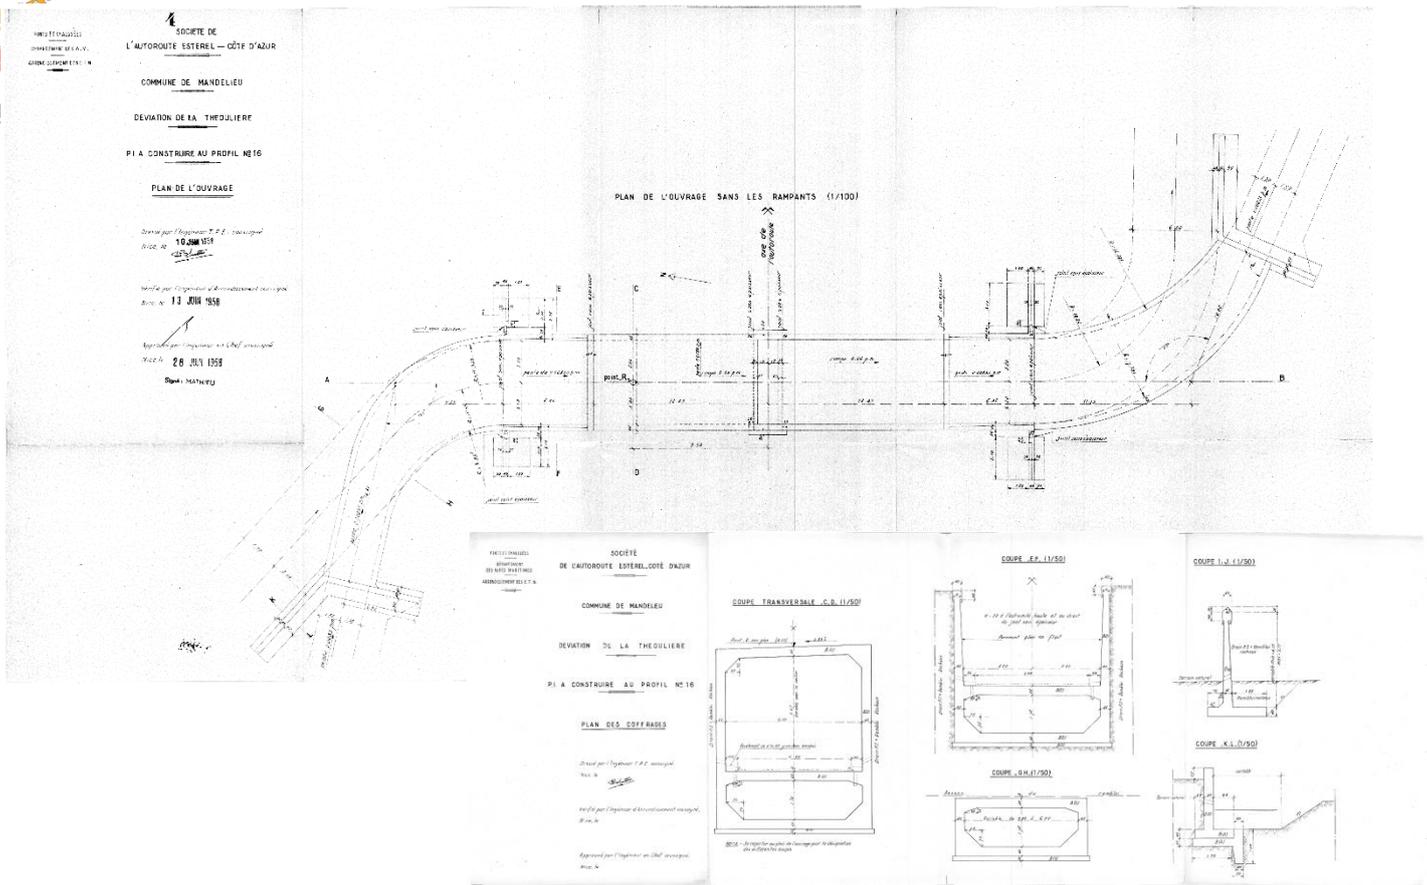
Plans de l'ouvrage ESCOTA situé sous l'avenue de la République
